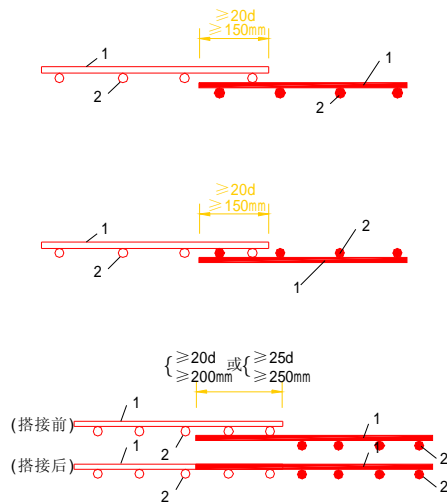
钢筋焊接网在非受力方向的搭接
